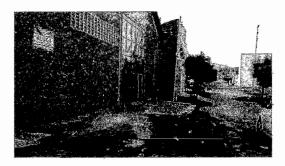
Logradouro (Rua Francisco Alfredo Cavalcante)
